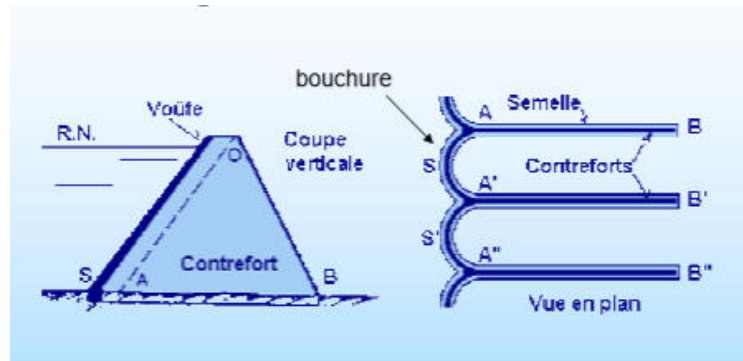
3 : Coupe transversale du barrage à contreforts. (Gramme 2006)
